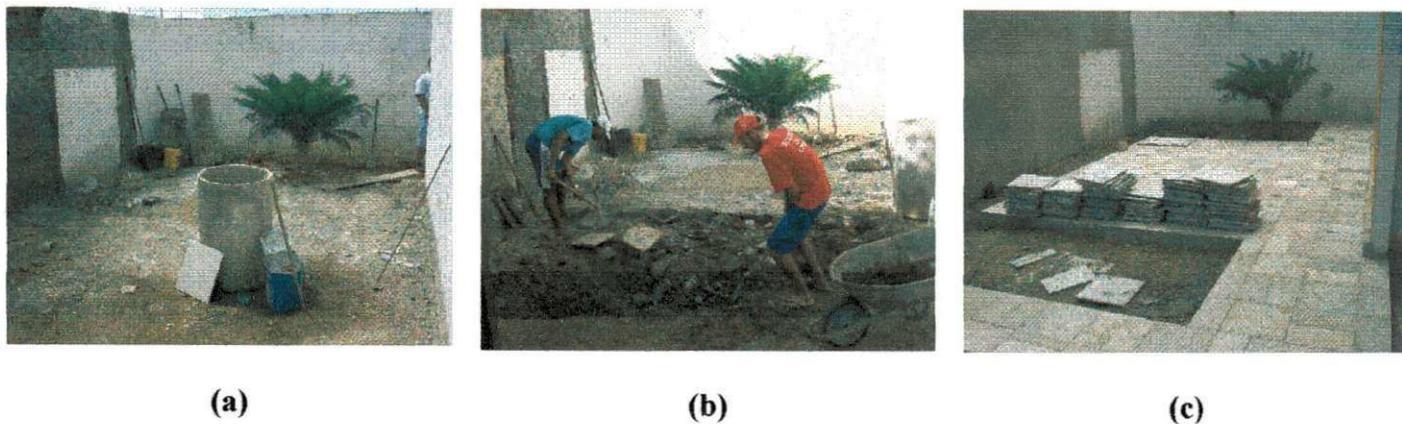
(a) local da construção antes das atividades; (b) início da escavação; (c) finalização da construção e acabamento.
